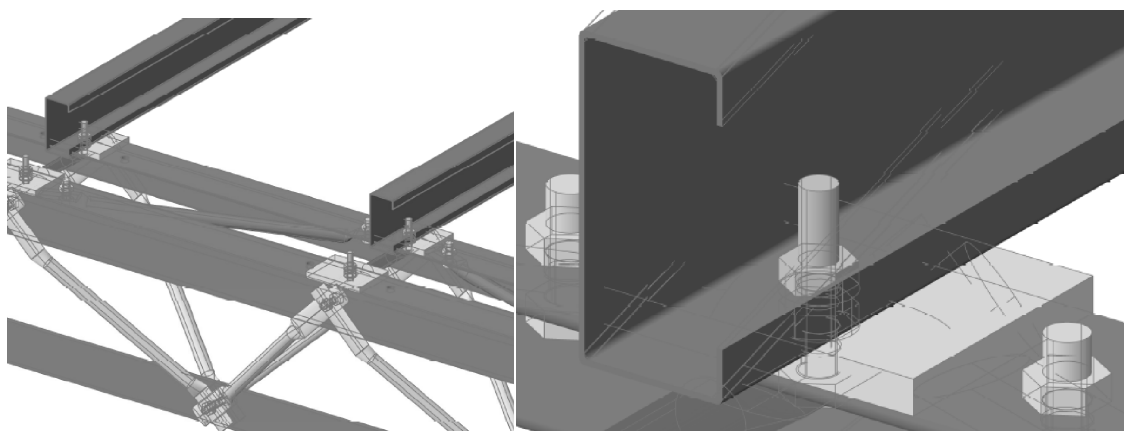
Pormenor 3D da ligação viga de piso com a estrutura principal
